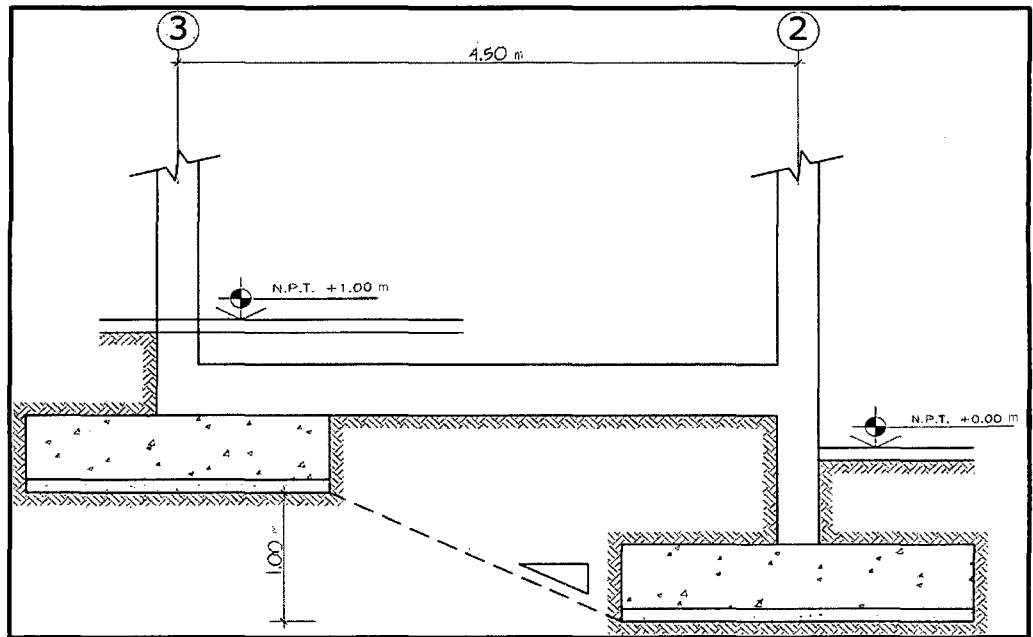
Elevación del planteamiento de zapatas a desnivel.
